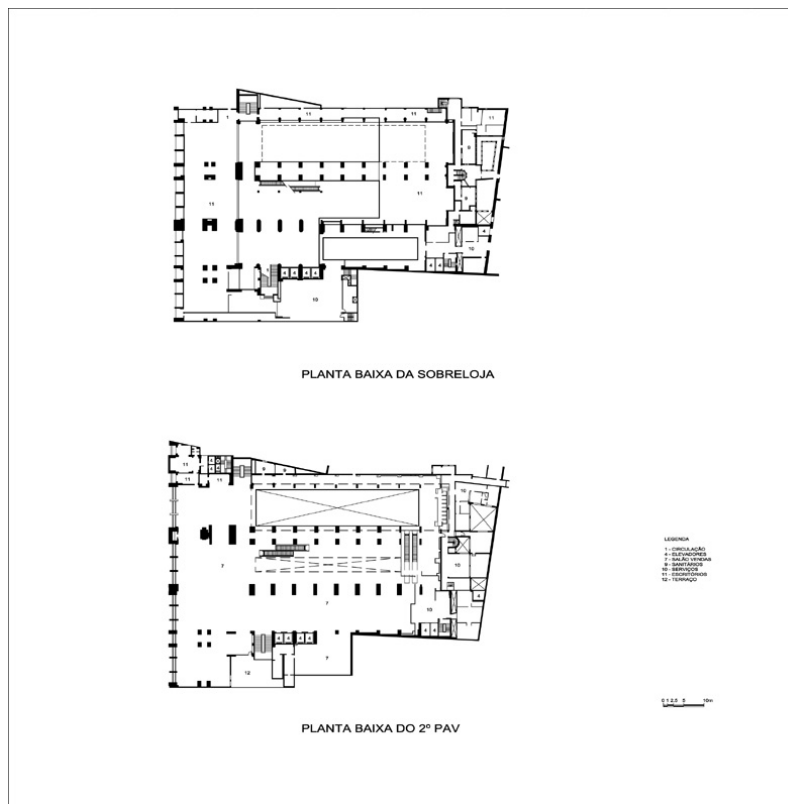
Planta baixa da sobreloja e 2º pavimento
